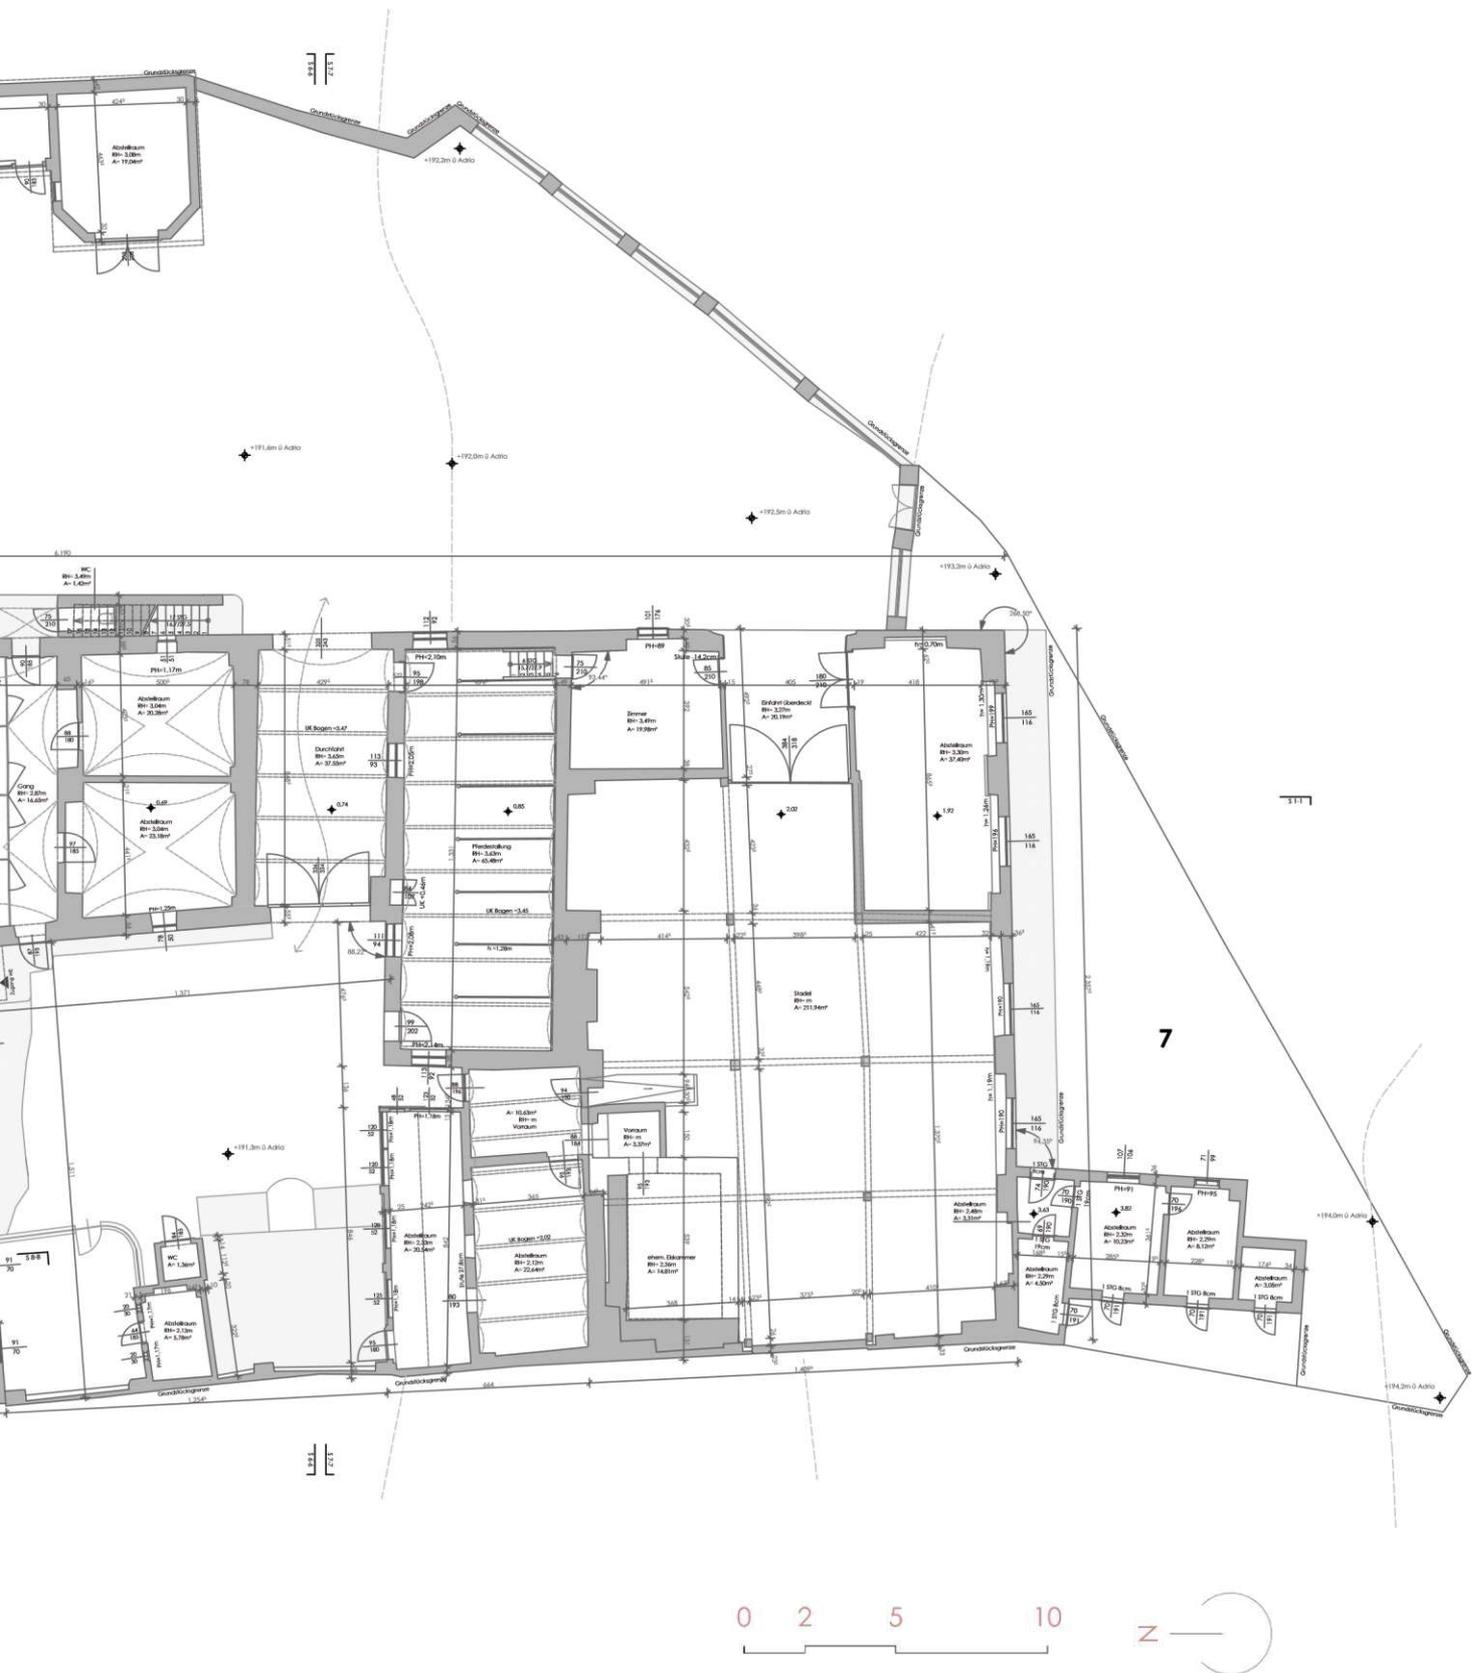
Bestandsplan Grundriss Erdgeschoss-Übersichtsplan
